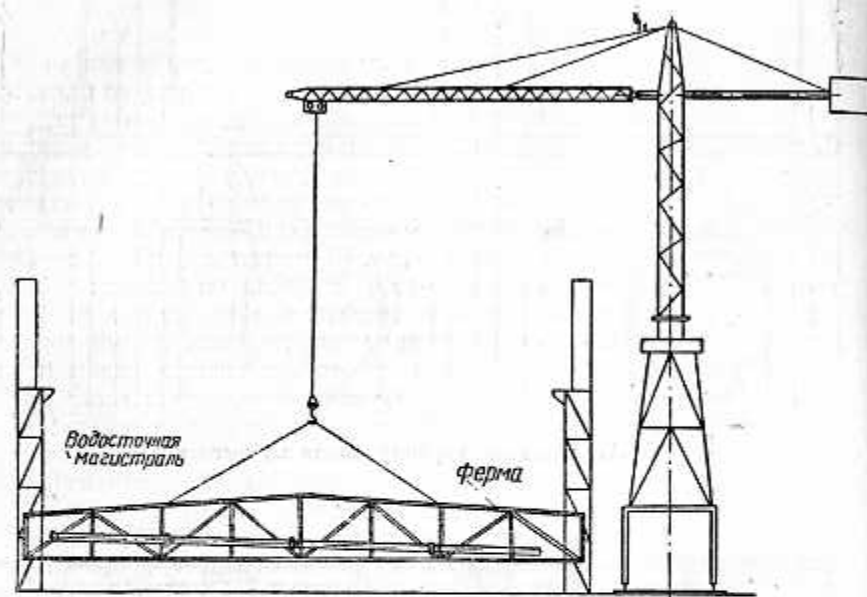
Закрепление водосточной сети на ферме до подъема на колонны
